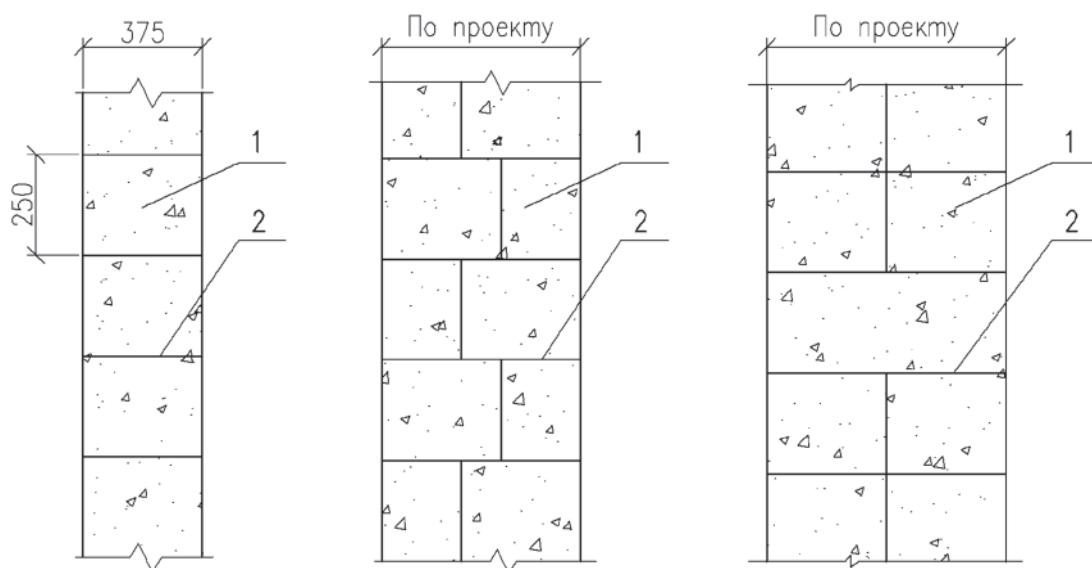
Схема однородной кладки стен из газобетона без наружной отделки:
